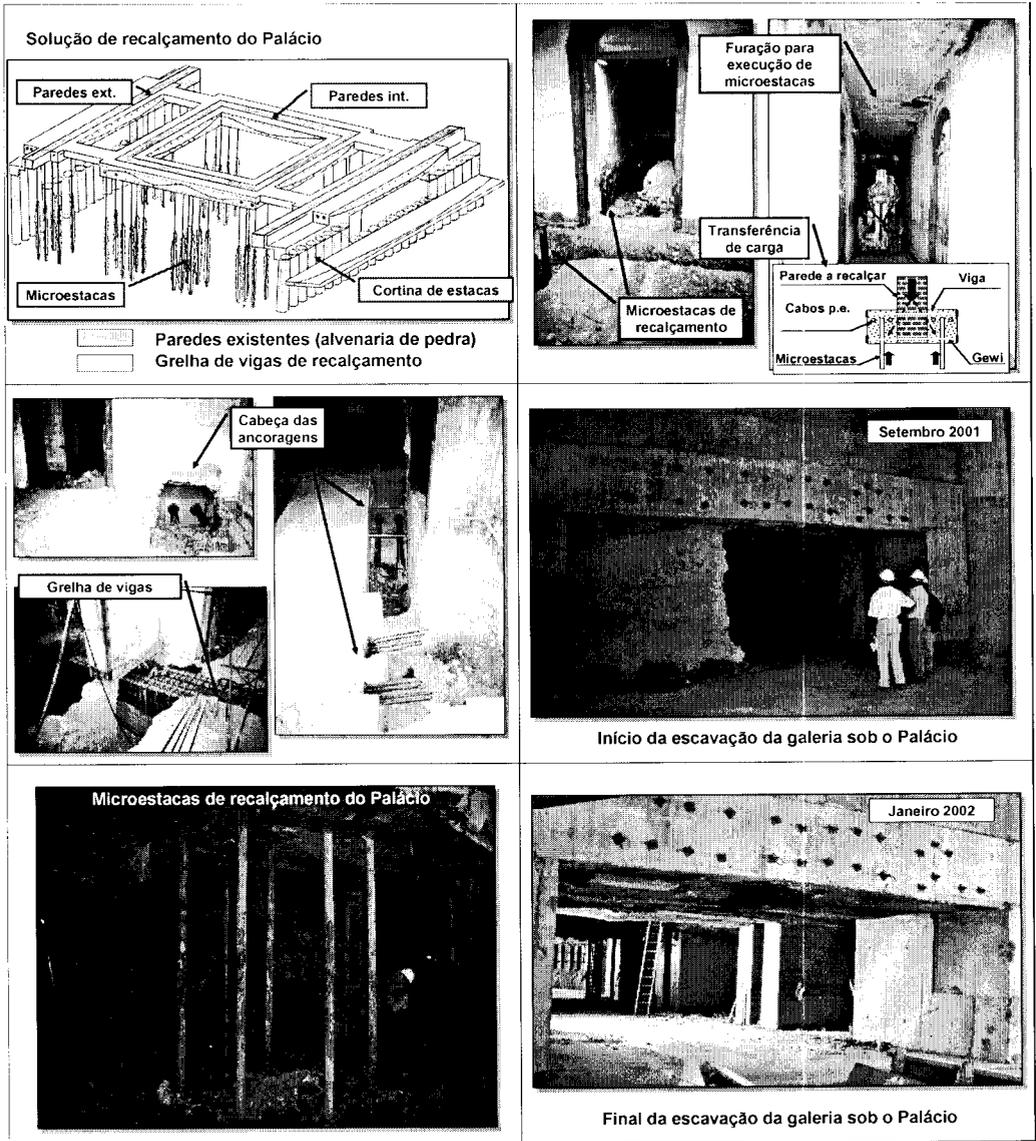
Solução e vistas da intervenção de recalçamento.
